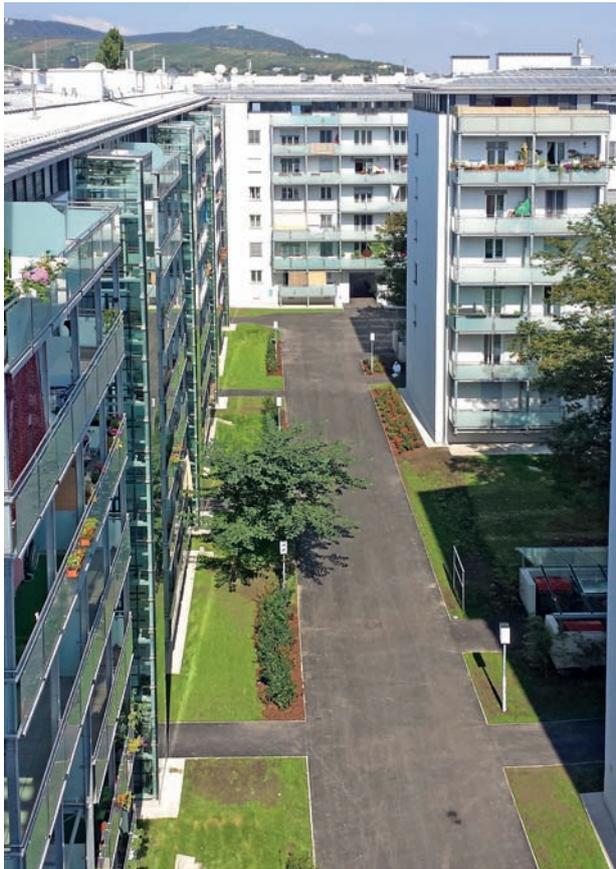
Hofansicht der Wohnhausanlage Kapaunplatz 7 mit neuen thermisch getrennten Balkonen und Dachgeschoßausbauten (links) [78]
